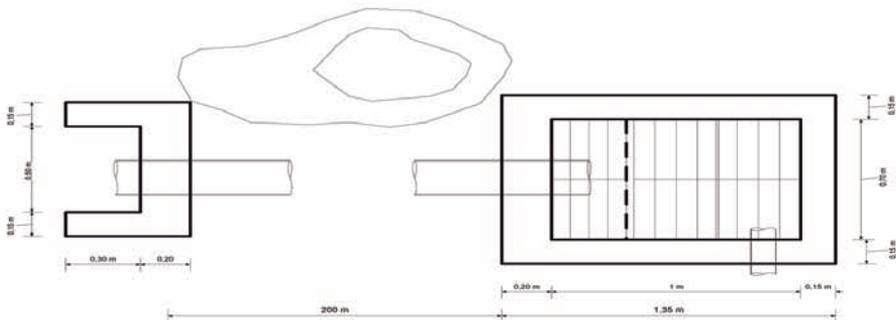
Diseño de planta del desarenador canal 1 en Cebollullo.
